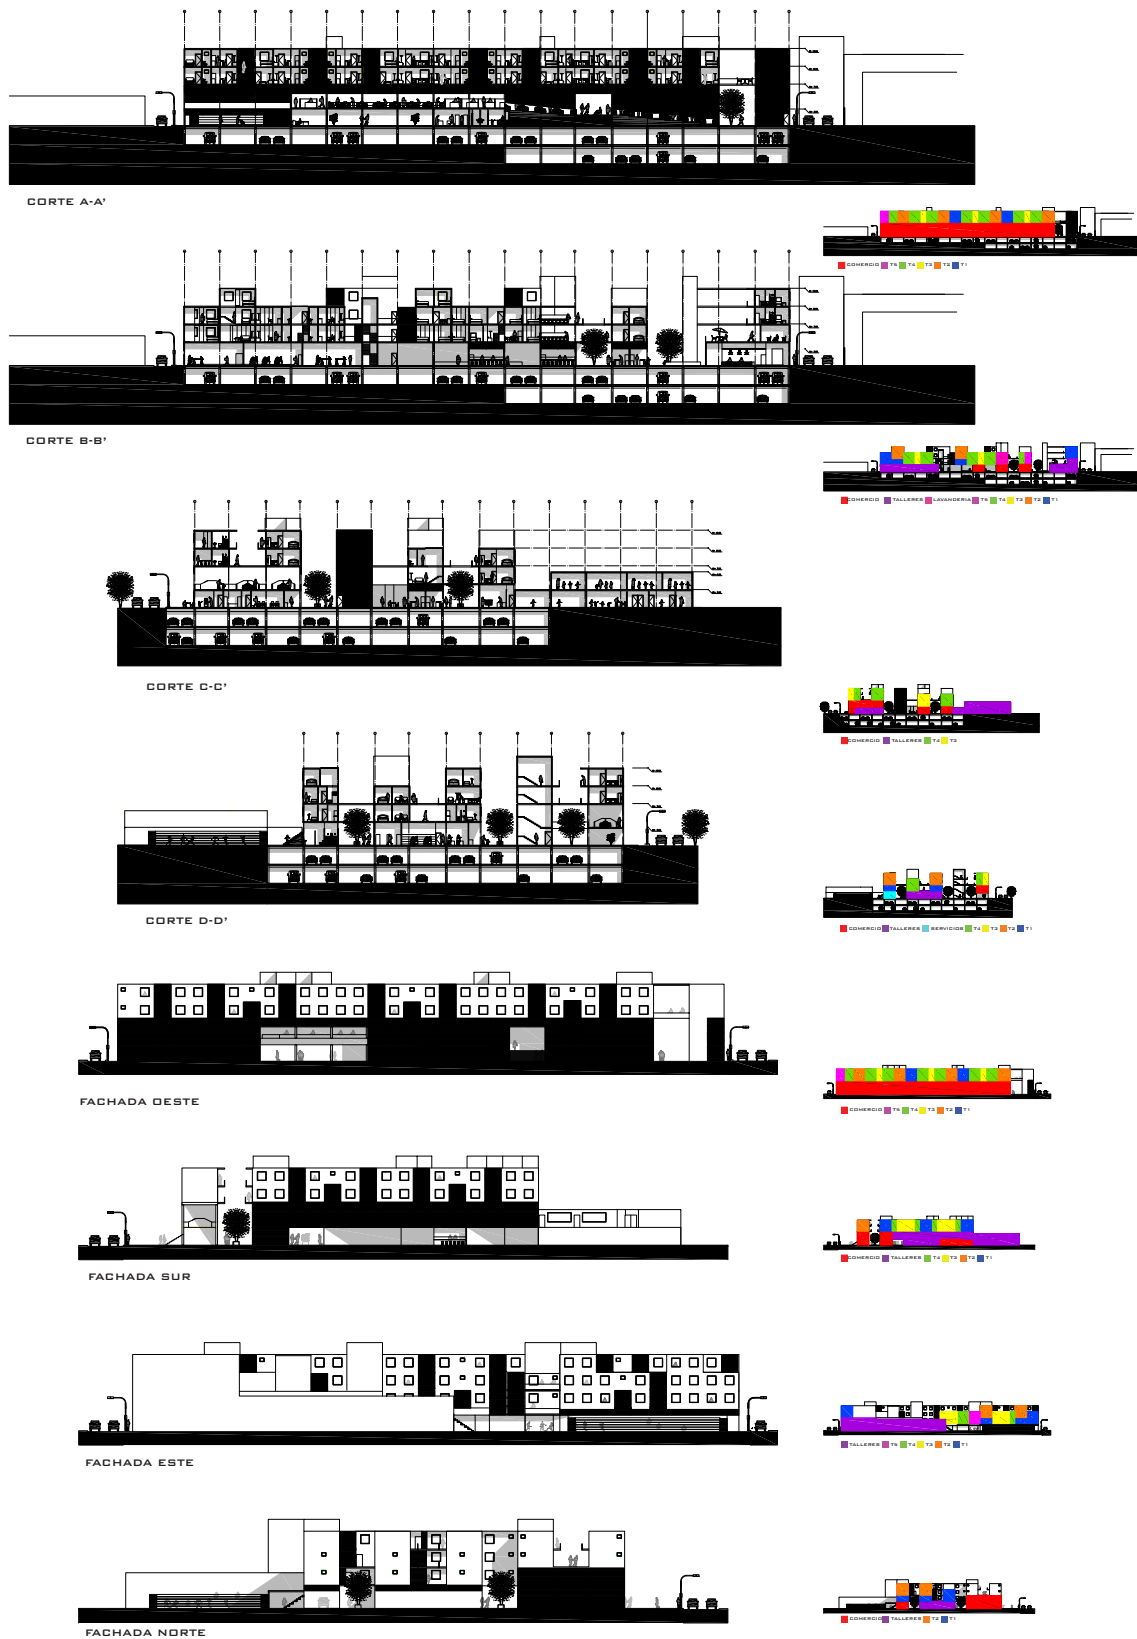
Cortes y fachadas del proyecto arquitectónico
